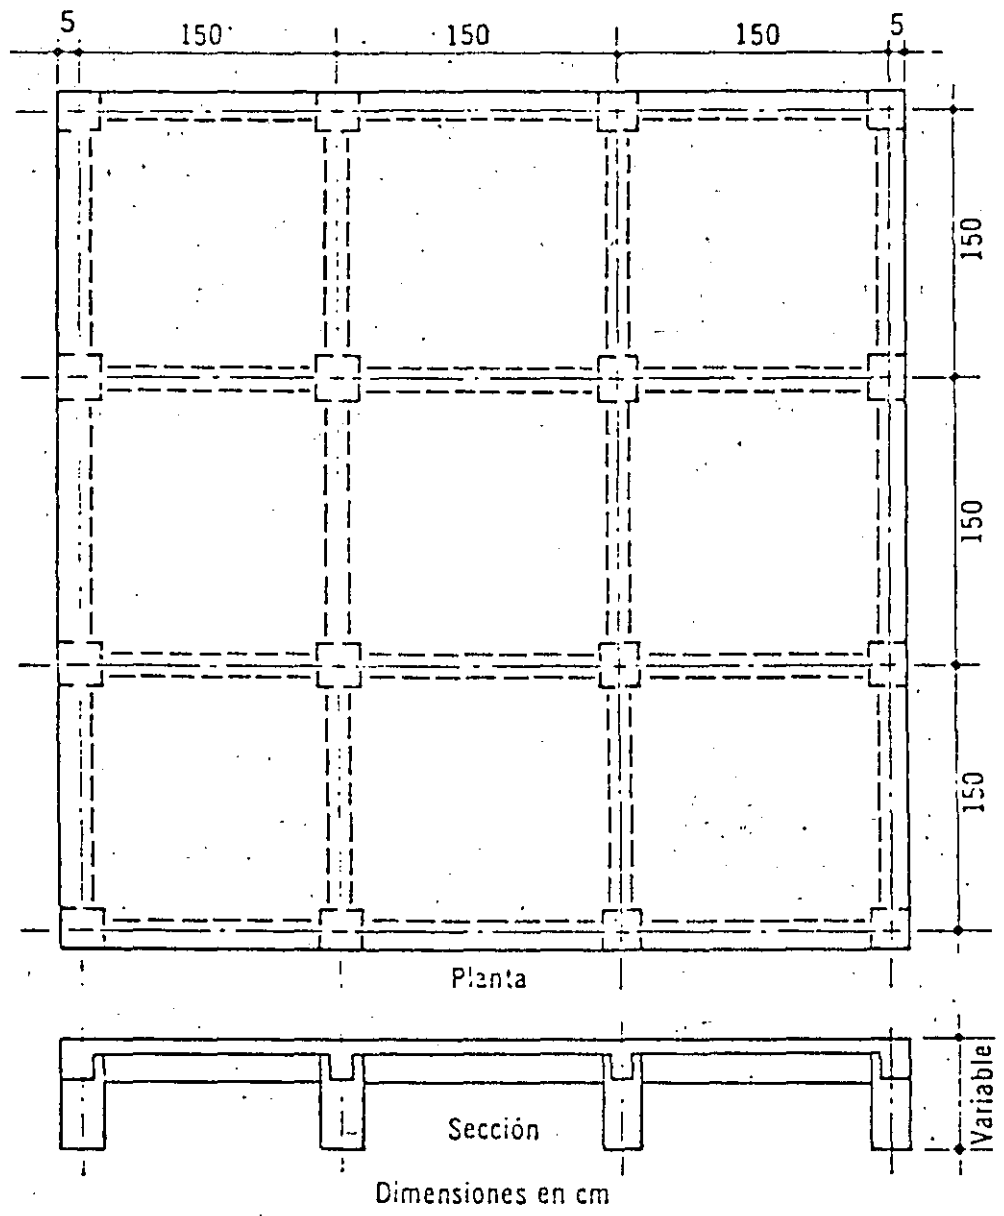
Planta típica de las estructuras ensayadas en la Universidad de Illinois
